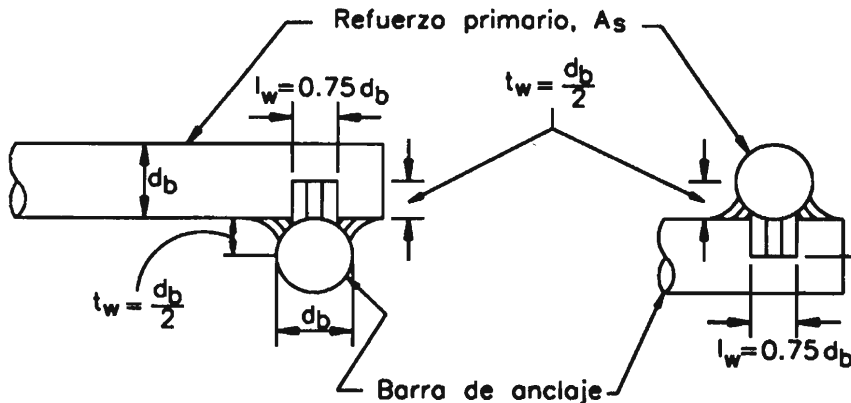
Soldadura utilizada para anclar el refuerzo principal en consolas
